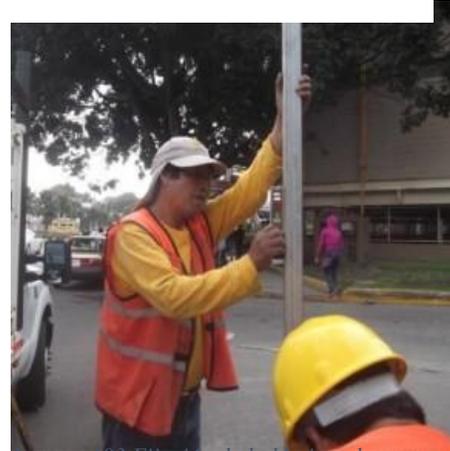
Fijación de la lamina al poste para la Instalación de SVB
